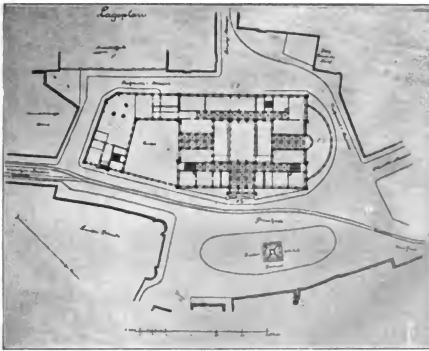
Lageplan des Postgebäudes an der Domshaide.
